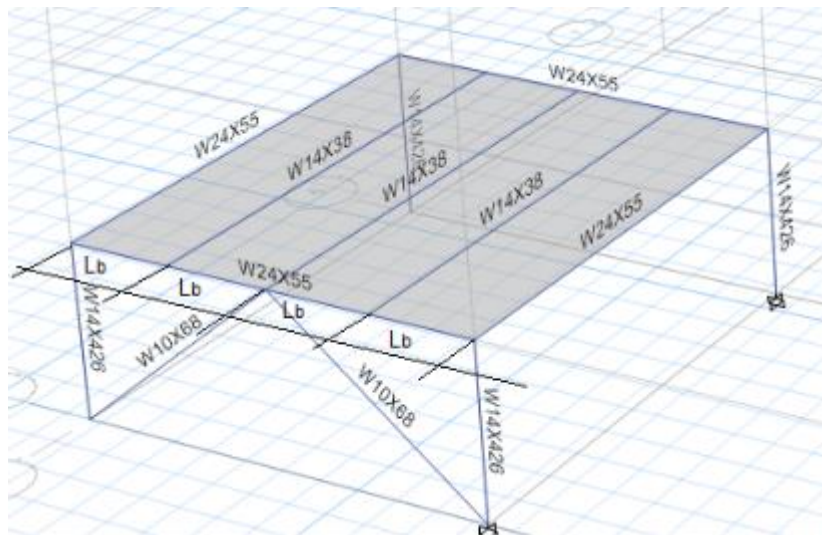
Longitud efectiva debido a vigas secundarias en viga maestra.
